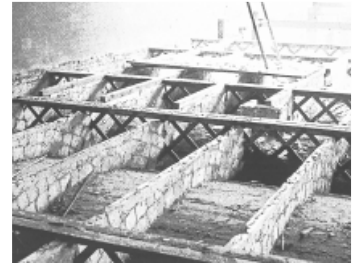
Construção de muretes para assentamento de pavimentos em abóbada tabicada [Argilés, Josep M. et al (1999a)]
